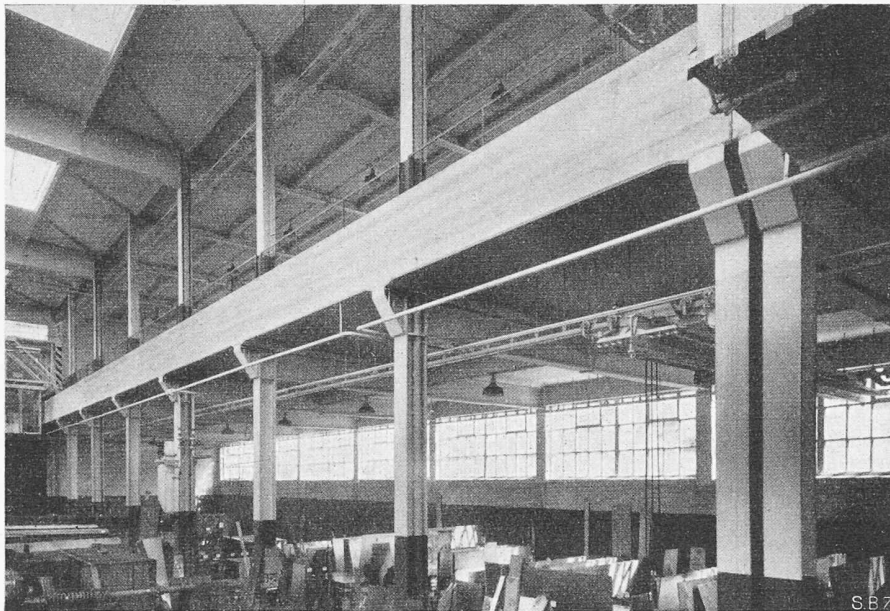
Blick in die Lagerhalle; Eisenbeton-Kranbahnträger
